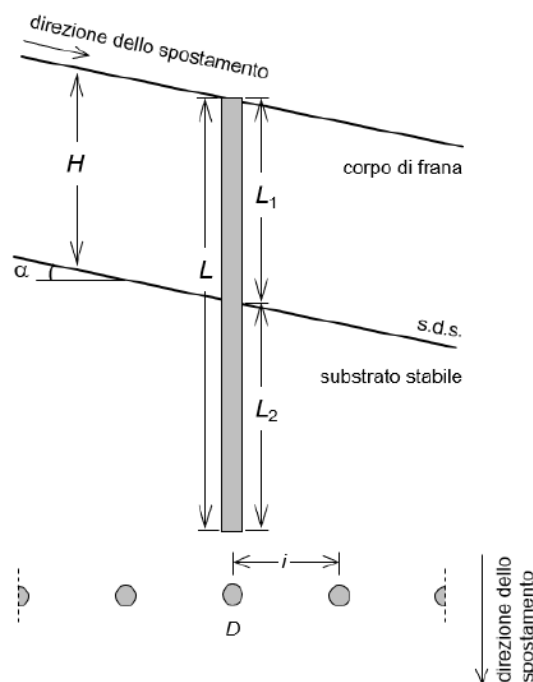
Sezione longitudinale (in alto) e vista in pianta (in basso) dello schema geometrico di riferimento
